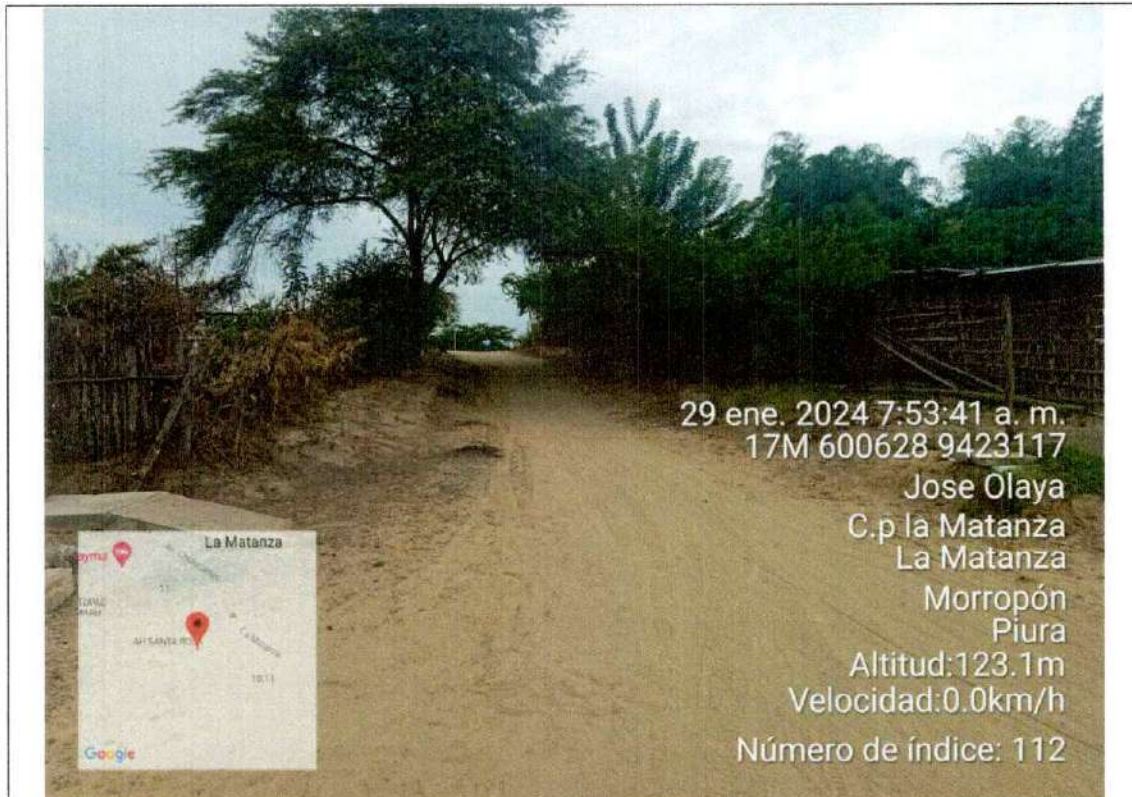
Vista del pasaje 01 del A.H. Santa Rosa
